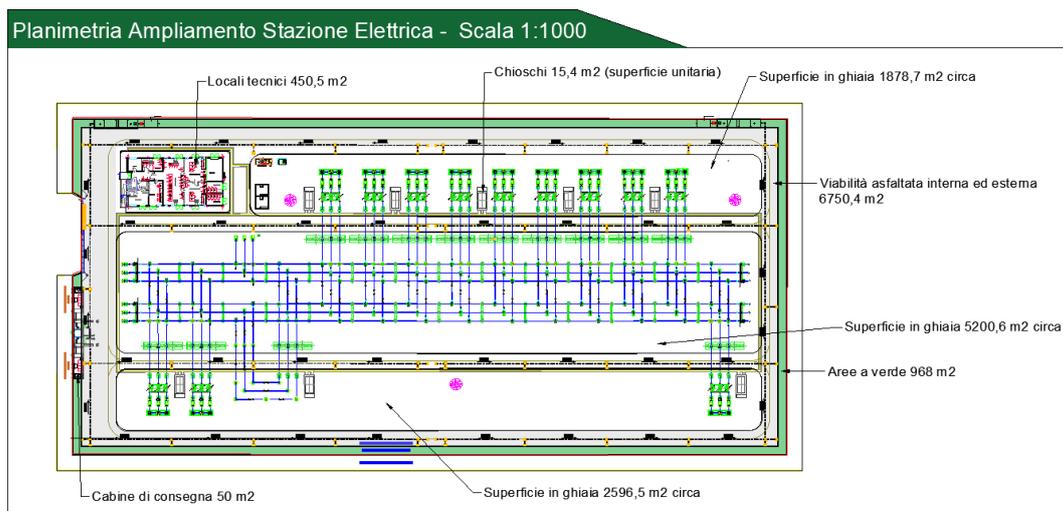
1 Planimetria superfici caratterizzanti la stazione elettrica
